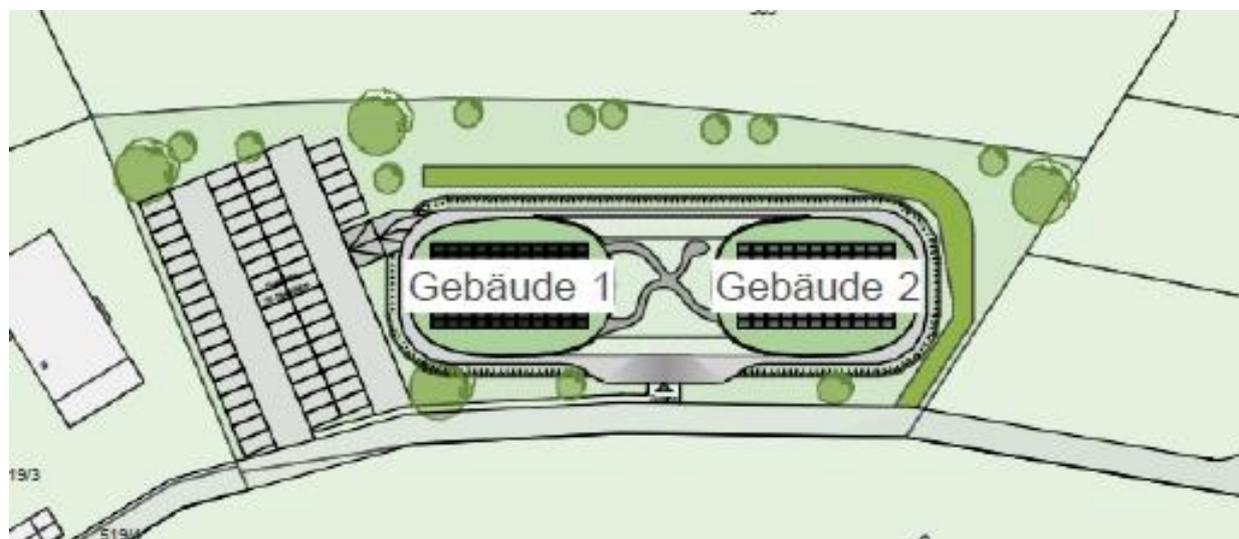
Lageplan Gesundheitszentrum, Matulus Garten GmbH, 11.02.2025
